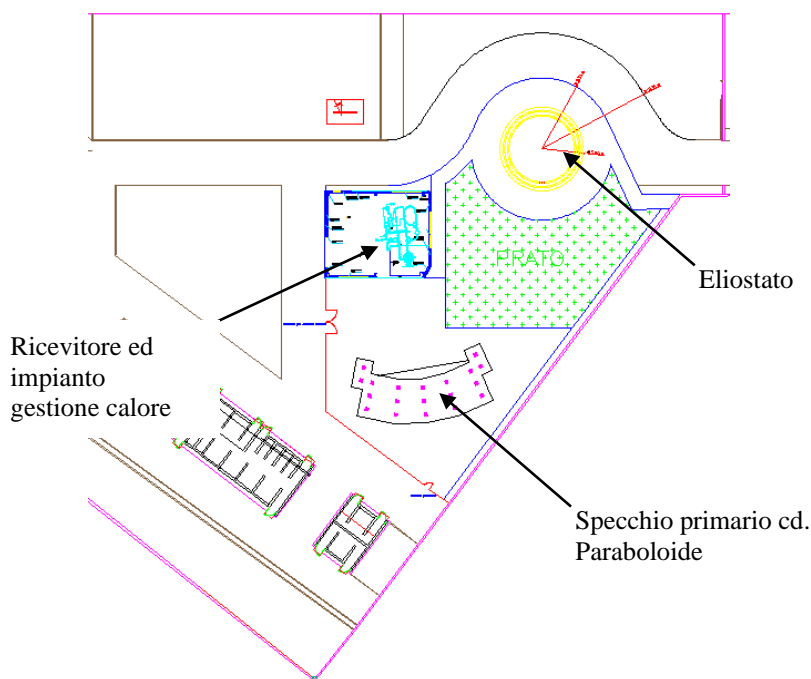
Planimetria dell'impianto Fornace solare EliosLab
